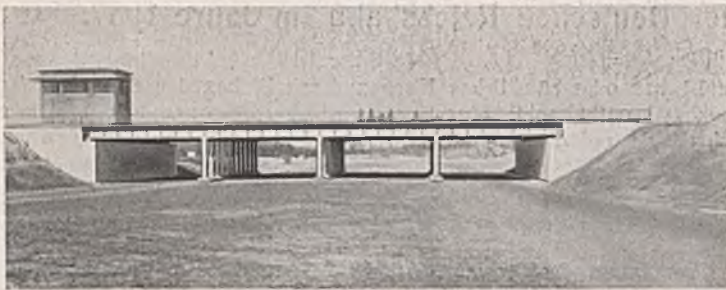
Straßenunterführung am Bahnhof Langwasser.
